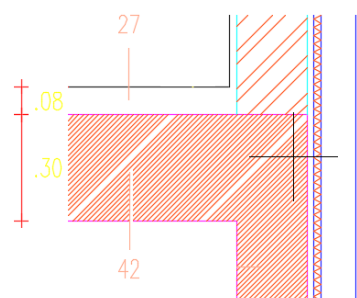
Constituição do pavimento do edifício C8 FCUL.
